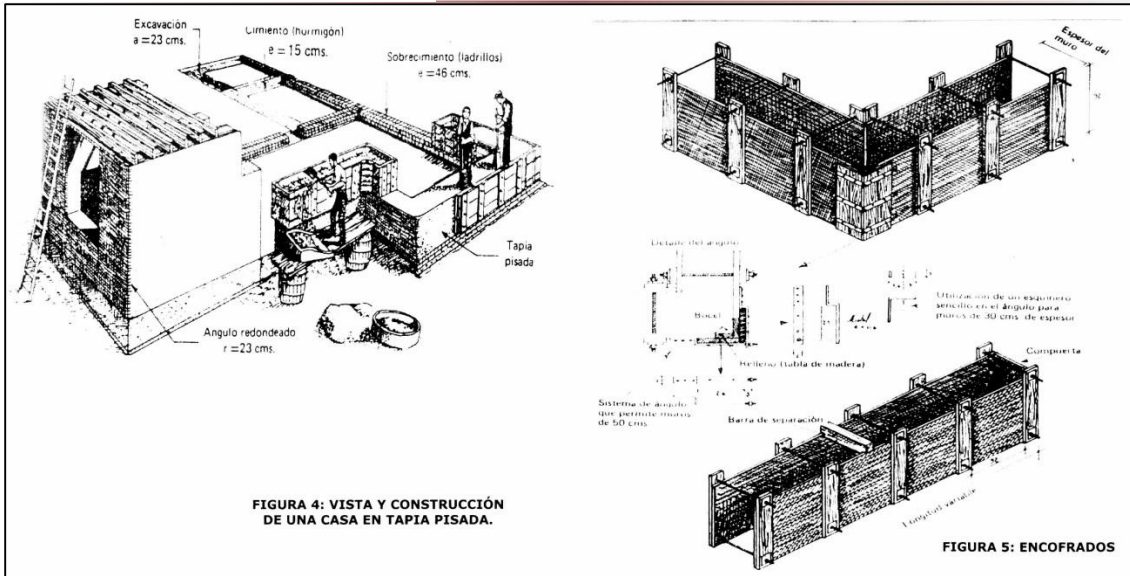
, Proceso constructivo de un muro en Tapia pisada, Fuente: Modulo de formación SENA, Construcción de muros en Tapia y Bahareque, 2012.
